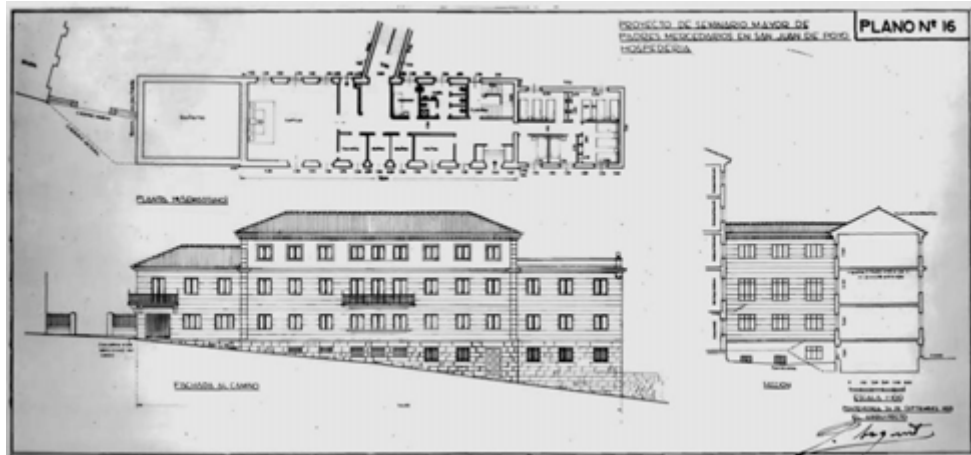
Fachada al camino. Fuente: Archivo Provincial.
